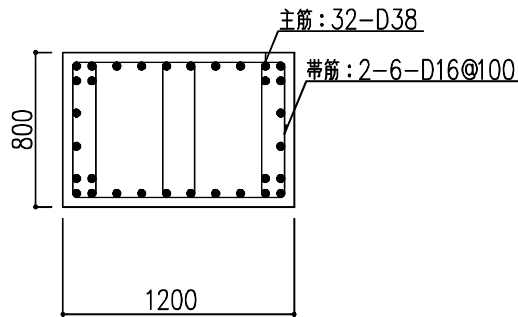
柱の配筋図 (地下2階, X34/YC 通り, 柱脚部) (単位: mm)
